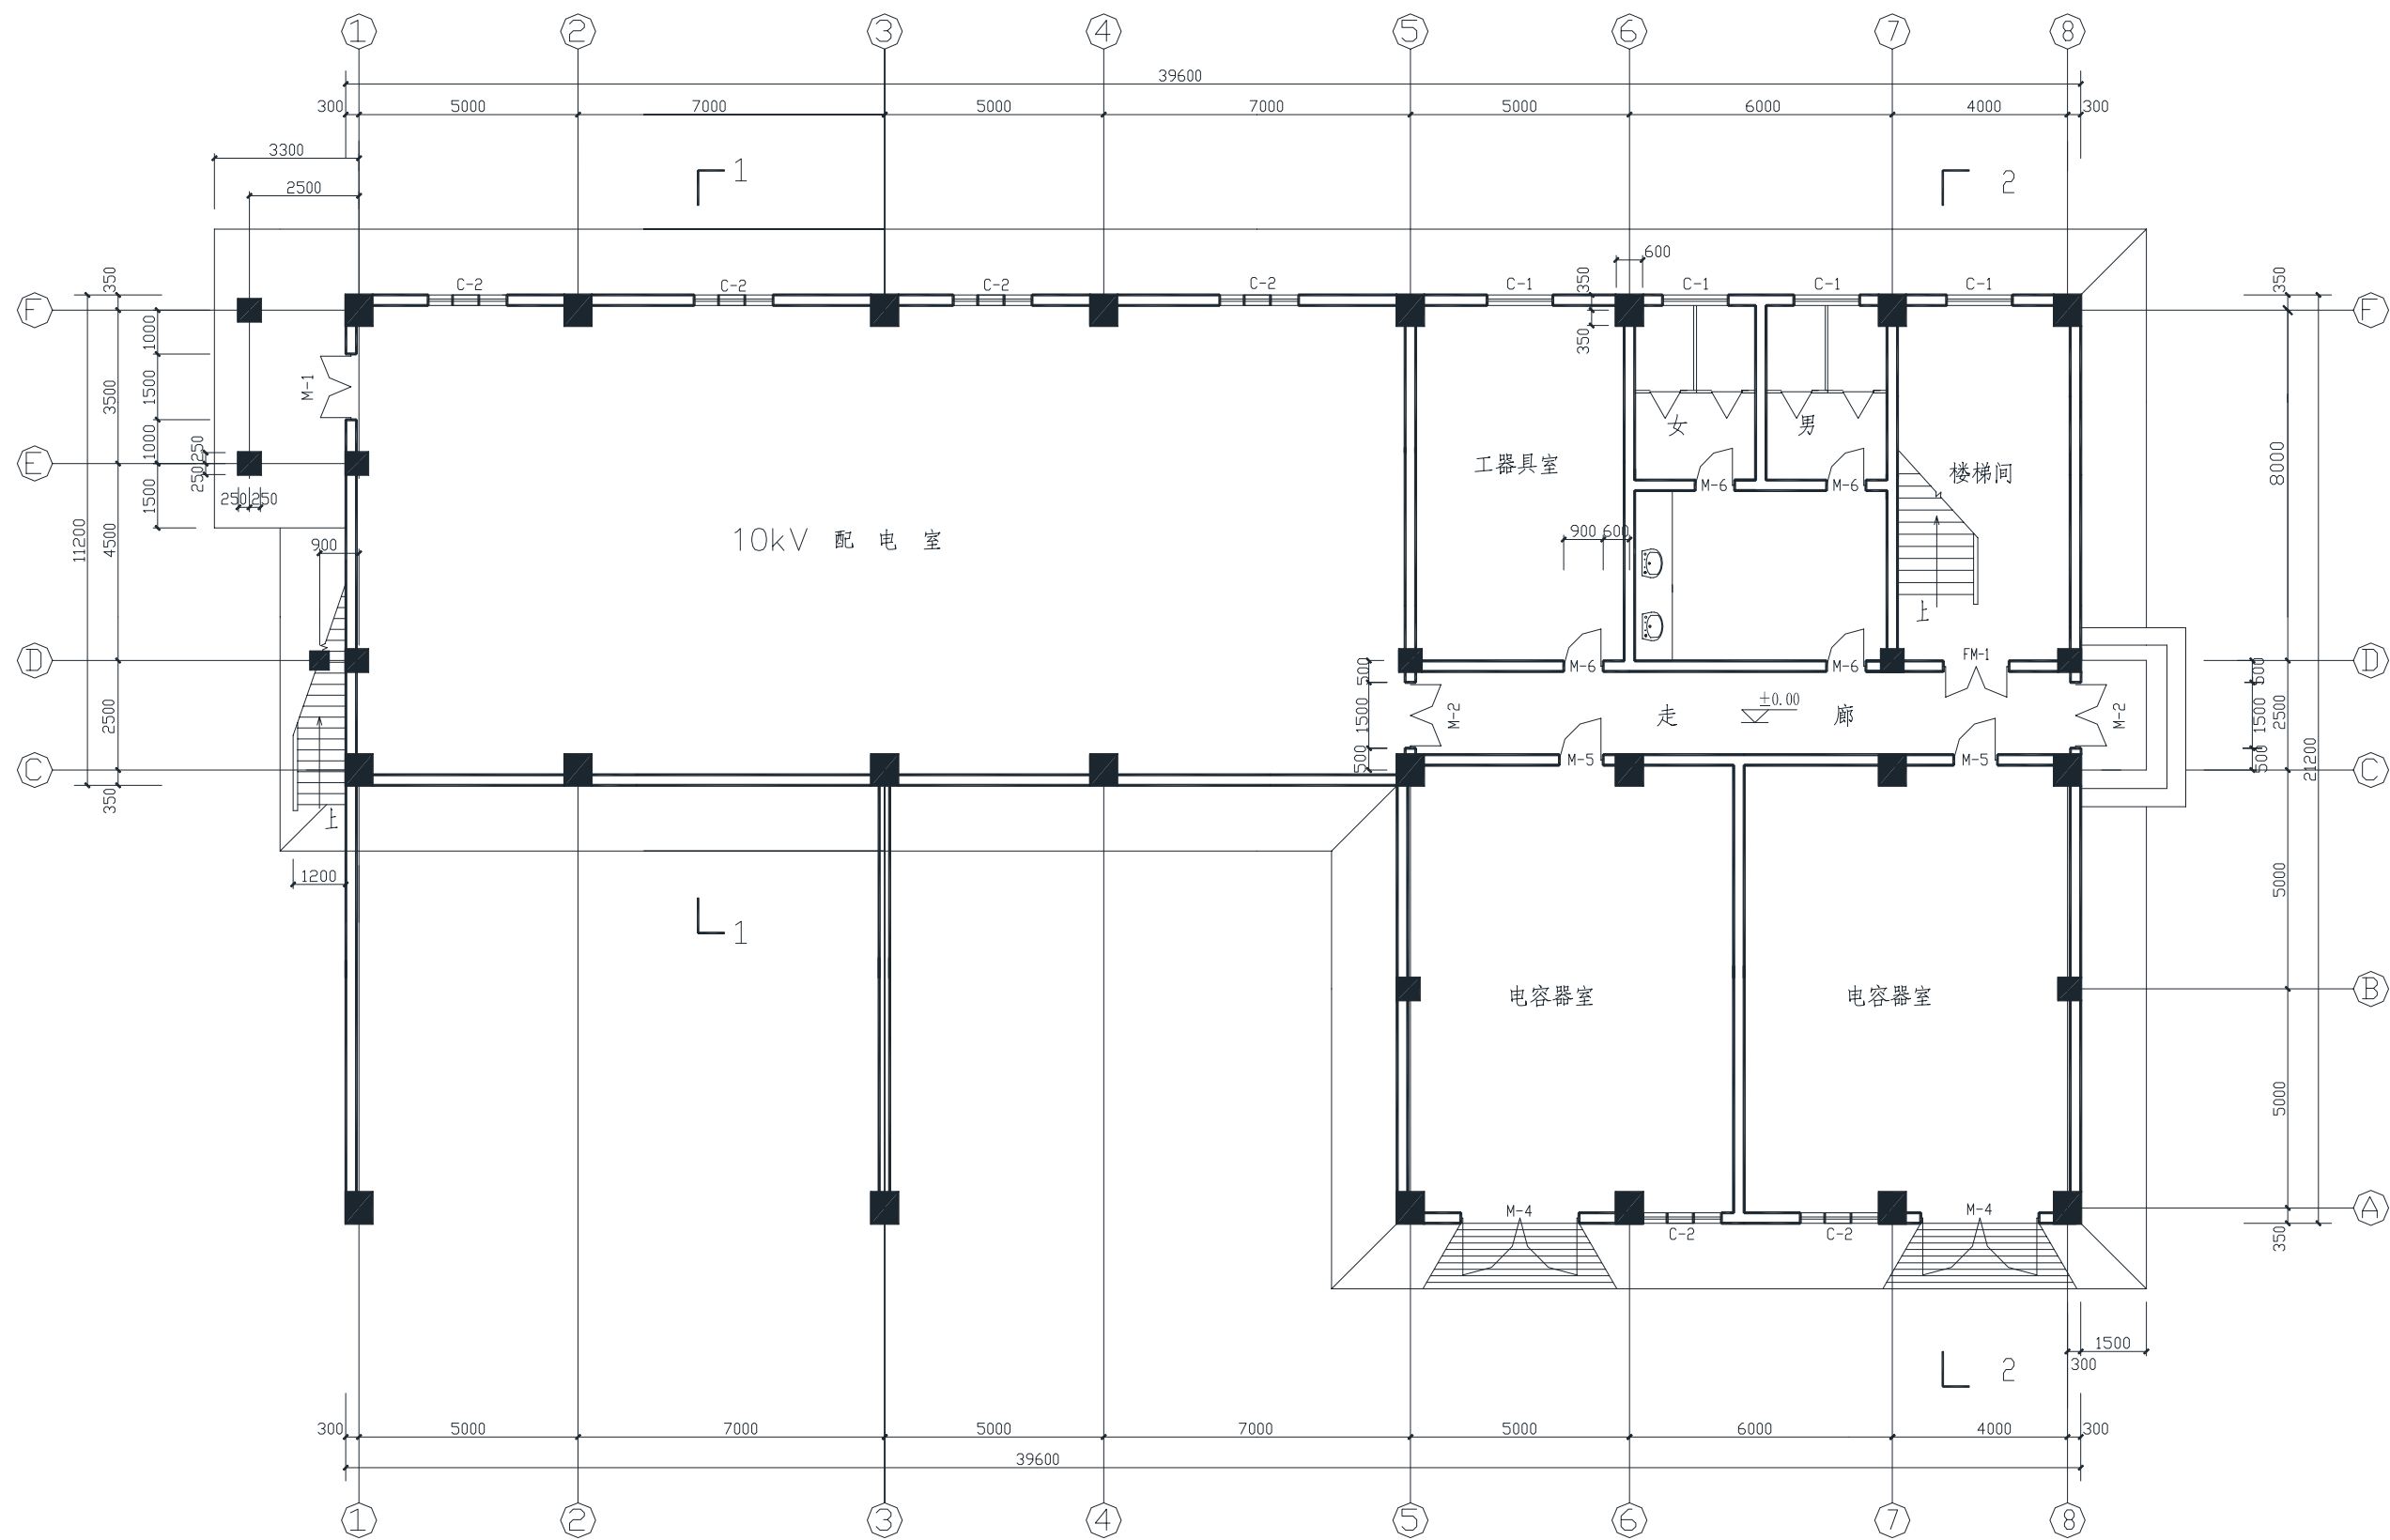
综合配电室一层平面布置图 (A3-1-05)
